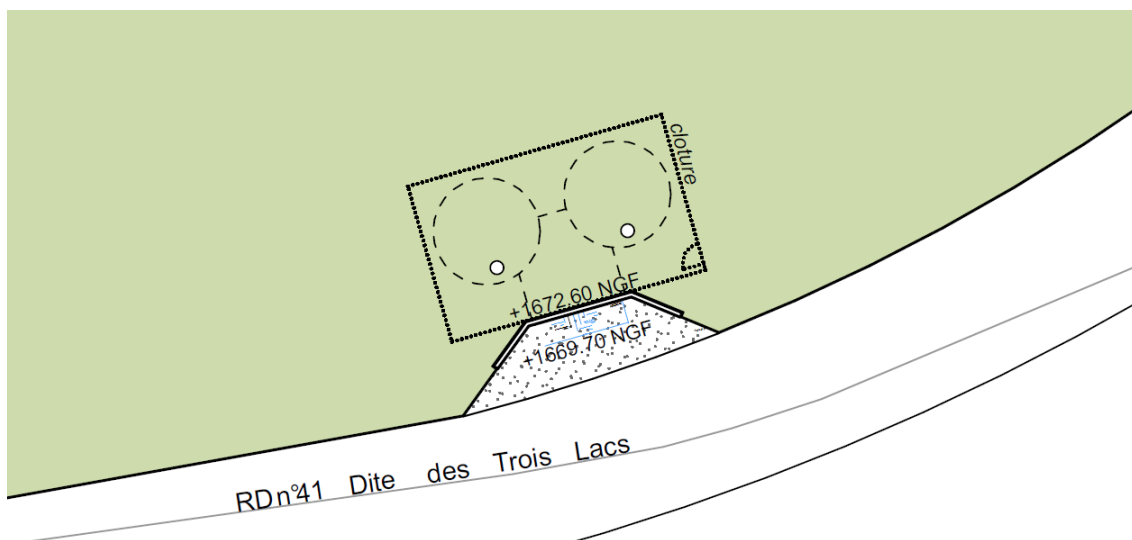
Plan d'implantation du futur réservoir (source Montmasson 2025)
